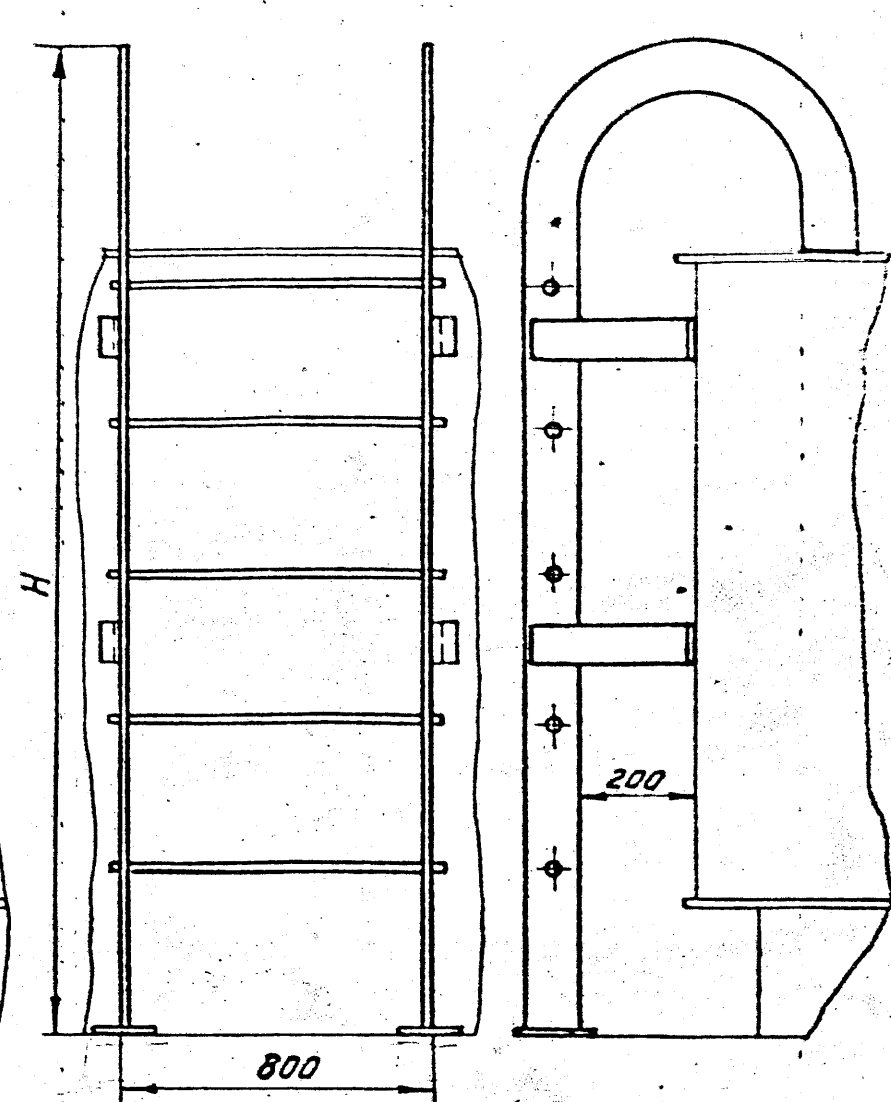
ЛЕСТНИЦА НАРУЖНАЯ
